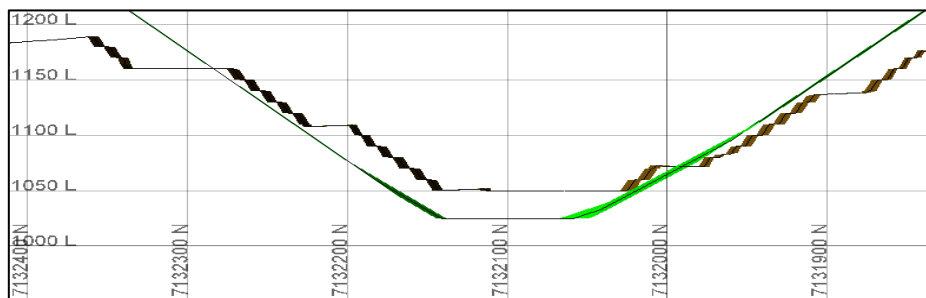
LPNB Fase 4 - Vista en sección - Corte secundario N-S E394400
